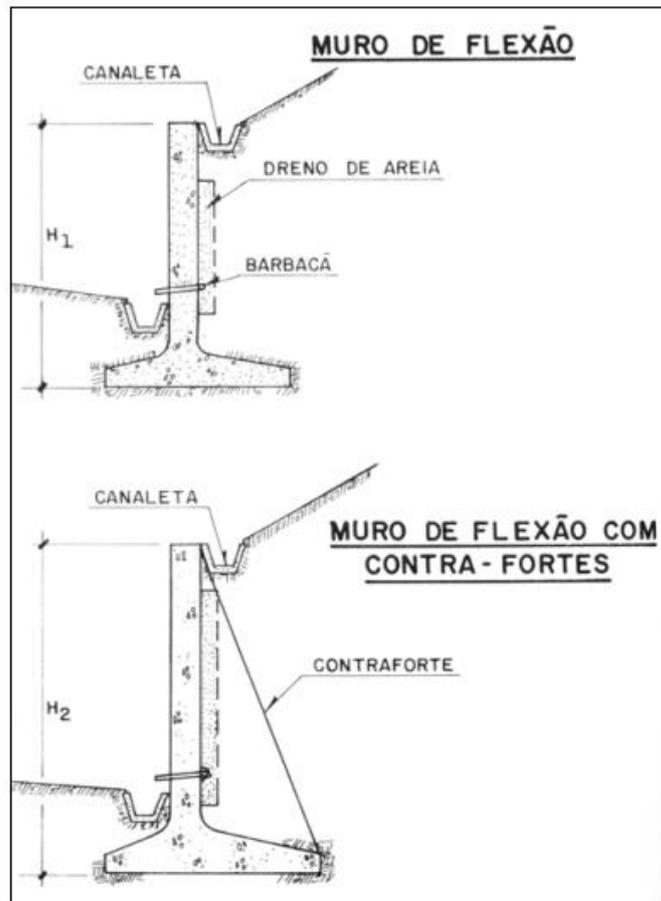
Muro de concreto armado. Fonte: UFSC.br²¹
